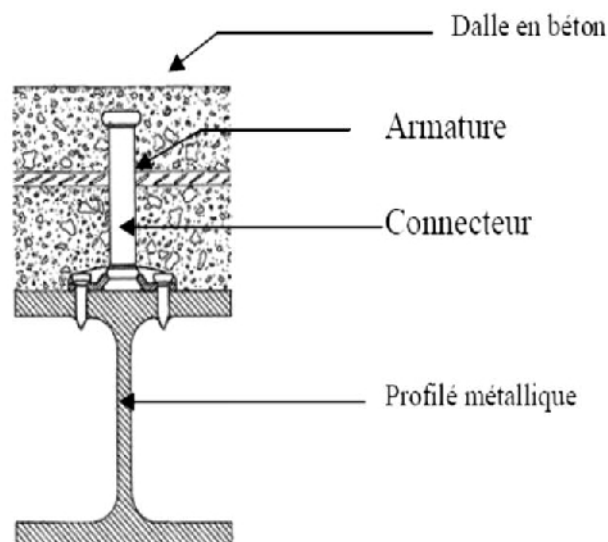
connexion entre la dalle en béton et le profilé. [26]
